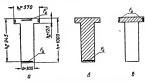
Поперечное сечение балки: a — поперечное сечение балки. b — сечение, учитываемое при расчет на вергикальные нагрузки: b — сечение, учитываемое при расчете на горизонтальные магрузки.
